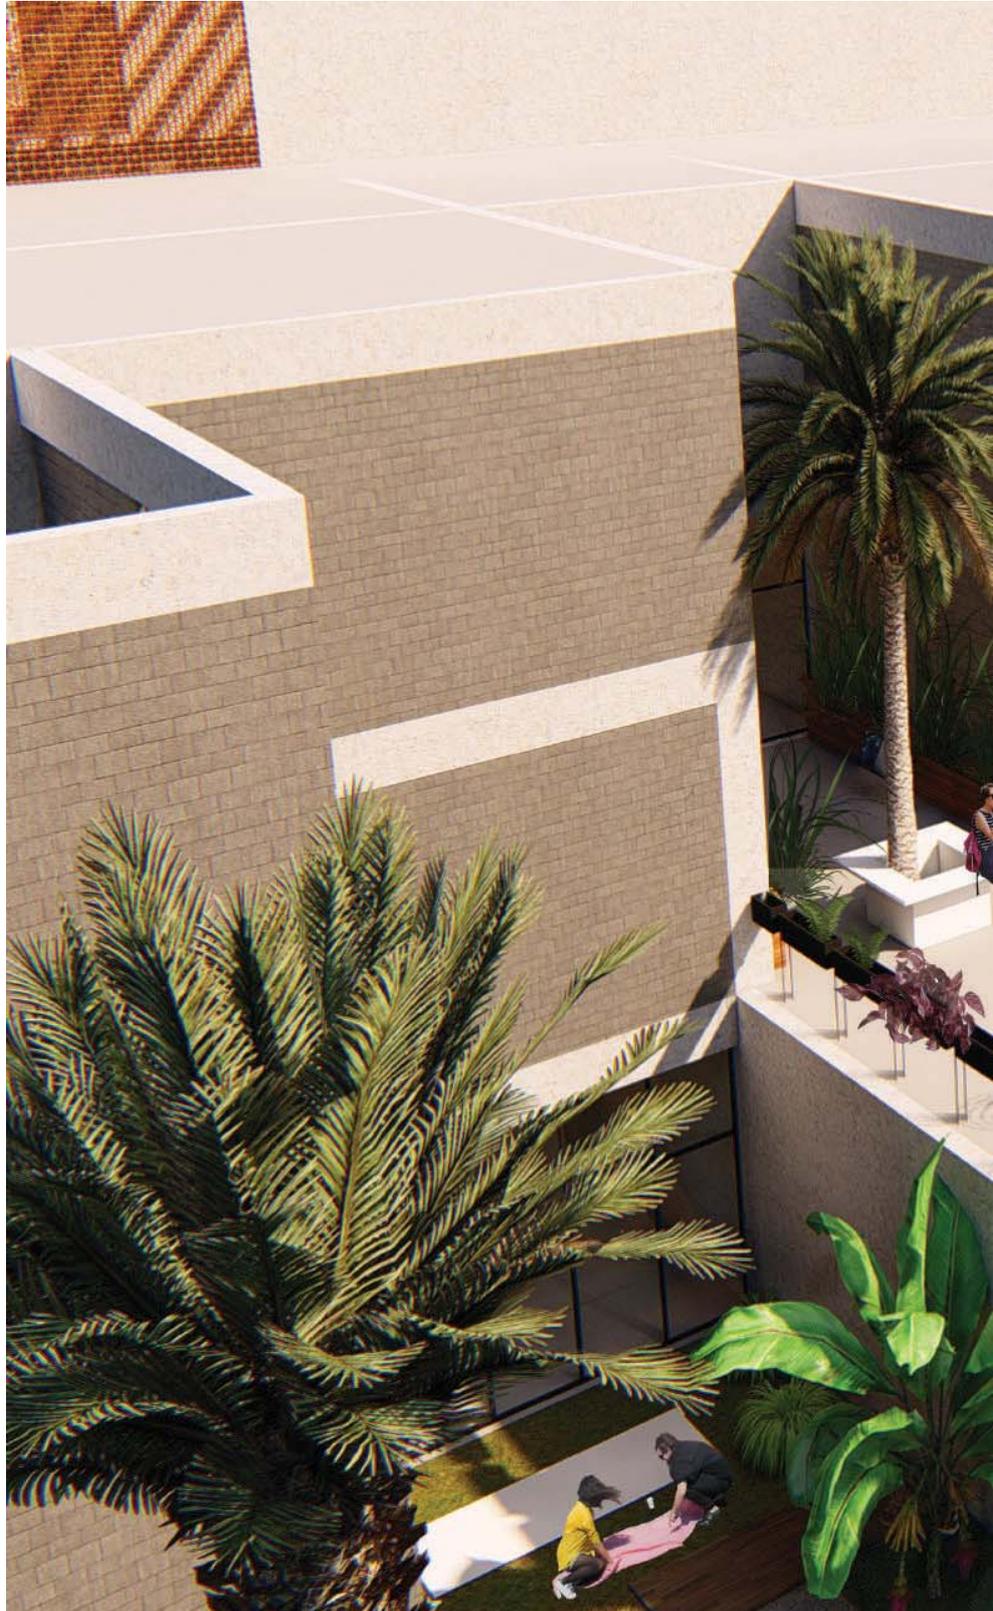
|| Render de vistas hacia el área libre lateral del proyecto, galería, librería y terraza del primer nivel.
